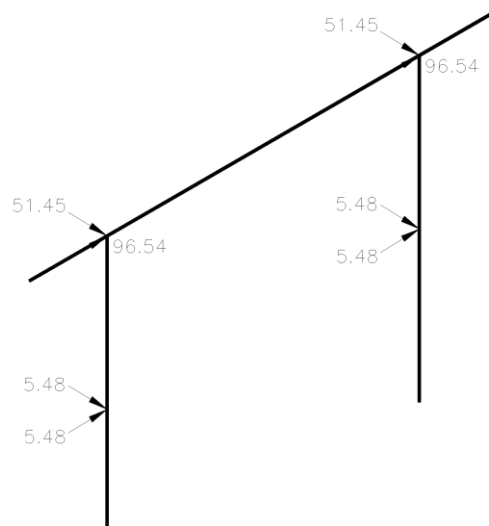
Cargas para grupo VII de apoyo intermedio.
